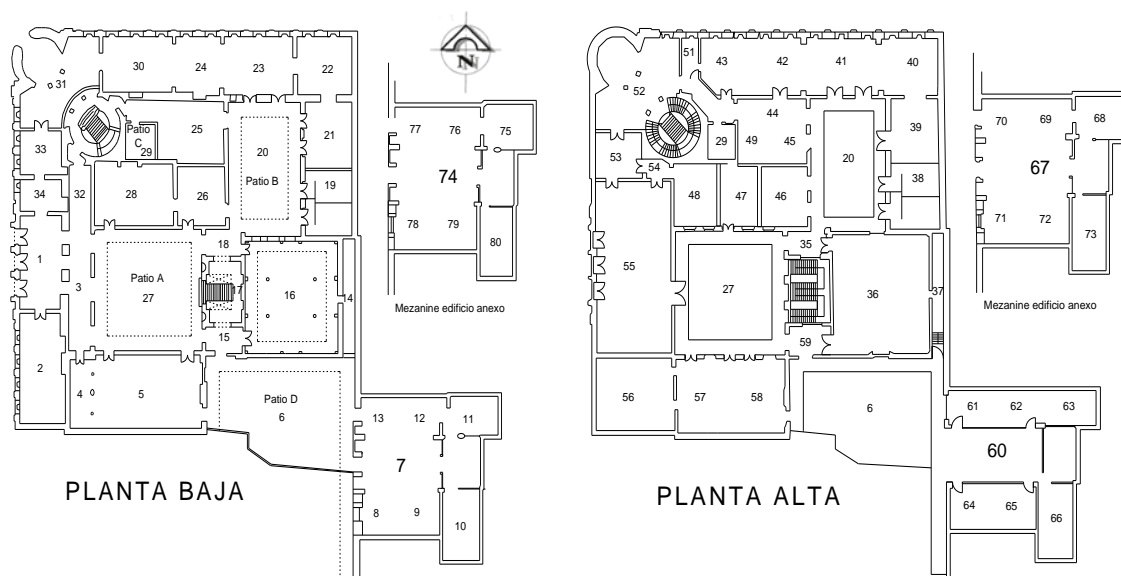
Planos en planta del Palacio de la Autonomía con referencias de los locales [2.16].
